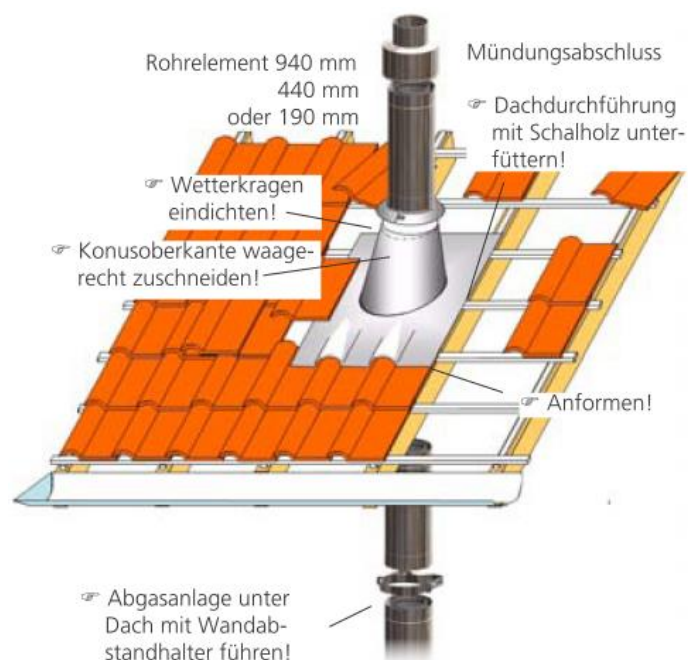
, Schrägdach mit typischer Edelstahl-Dachdurchführung
